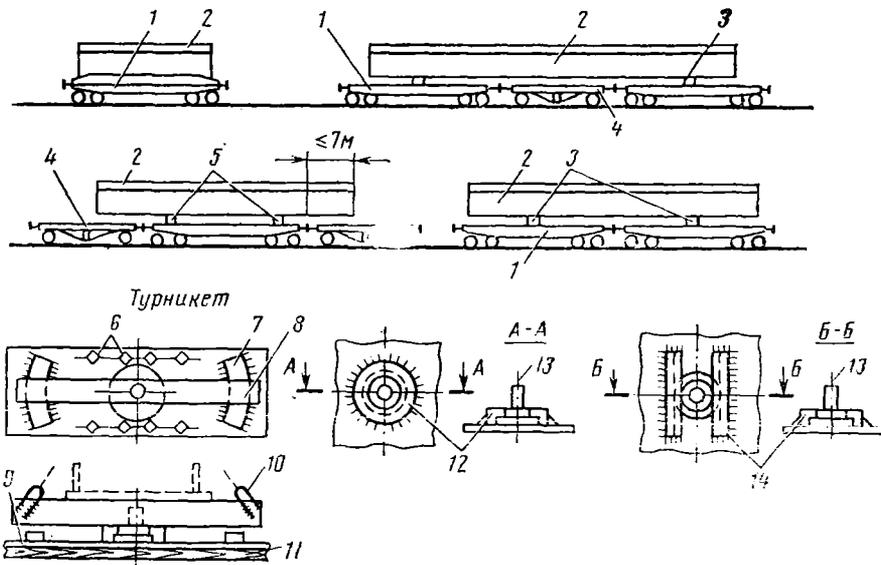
Схема расположения конструкций на платформах. Деталь крепления оси вращения турникета к листу:
